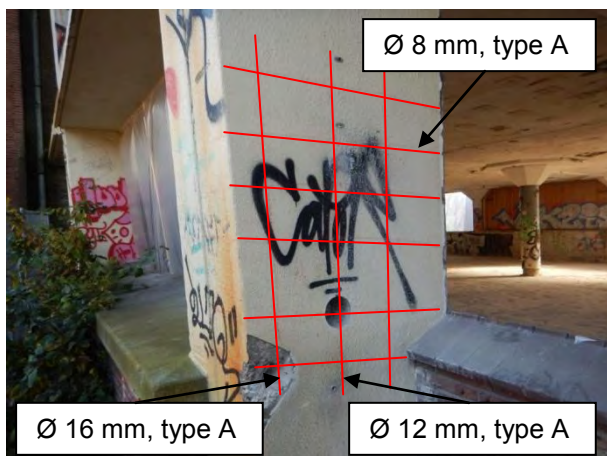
Overzicht wapeningsconfiguratie kolommen.
